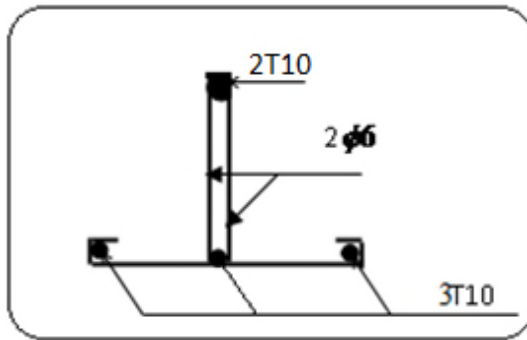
Schéma de ferrailage de la poutrelle type1.
